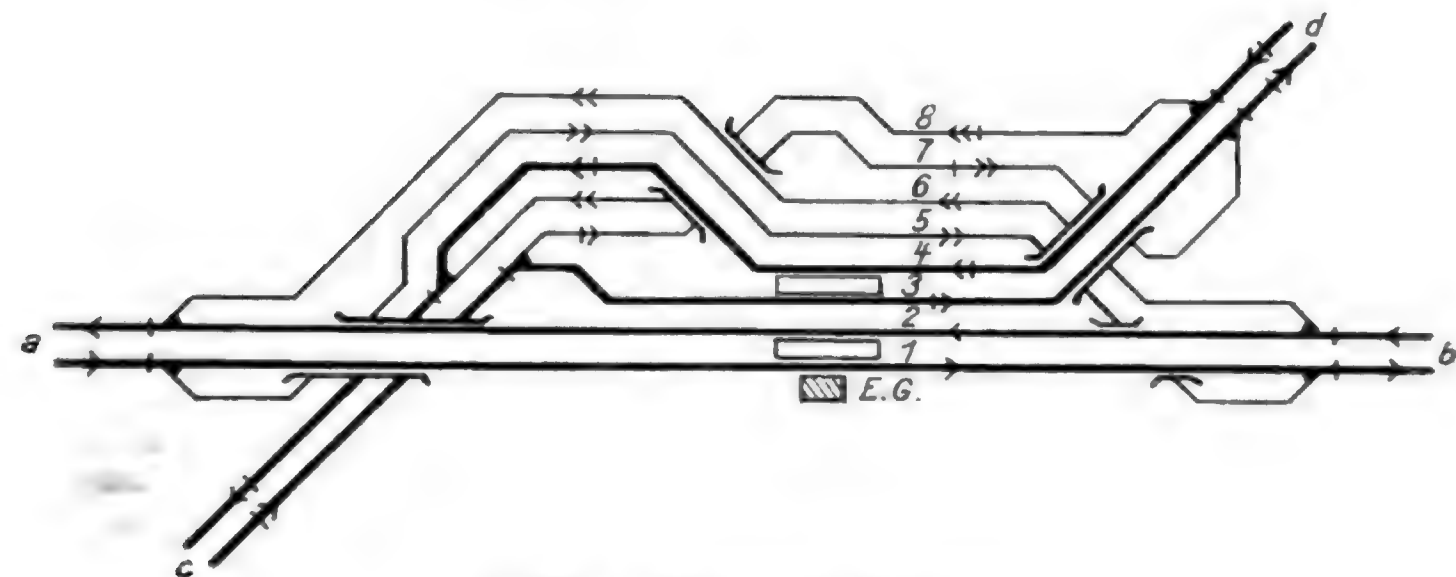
Beseitigung aller Hauptgleiskreuzungen.
